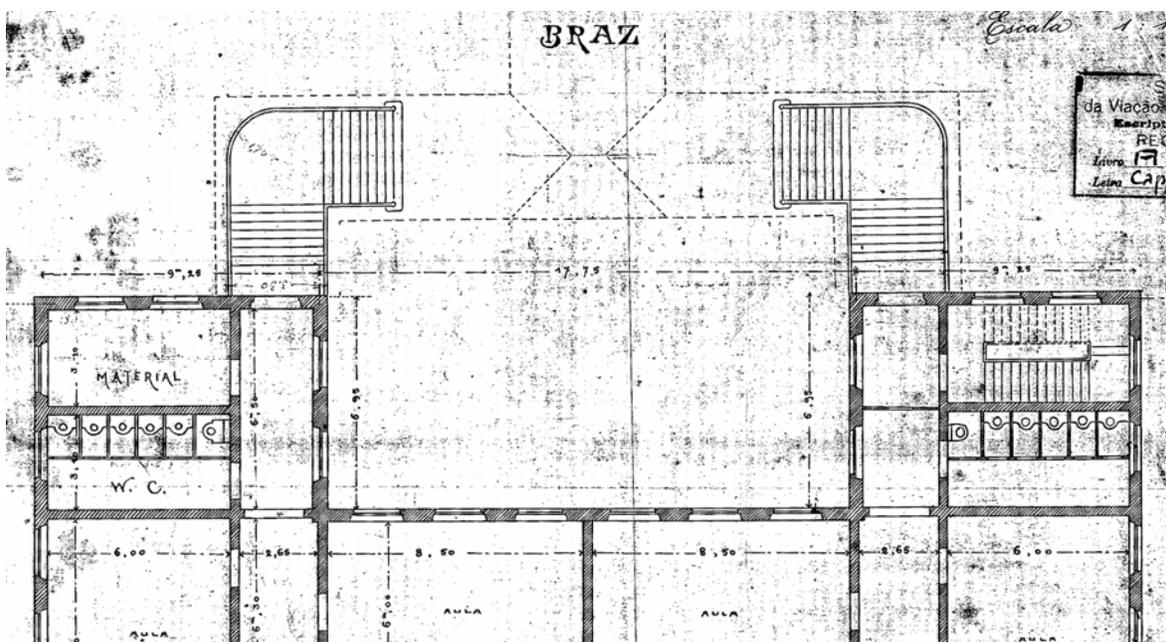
Detalhe da planta da saída para os fundos do 1º Pavimento do Grupo Escolar Padre Anchieta. (Fonte: Acervo CPOS)
